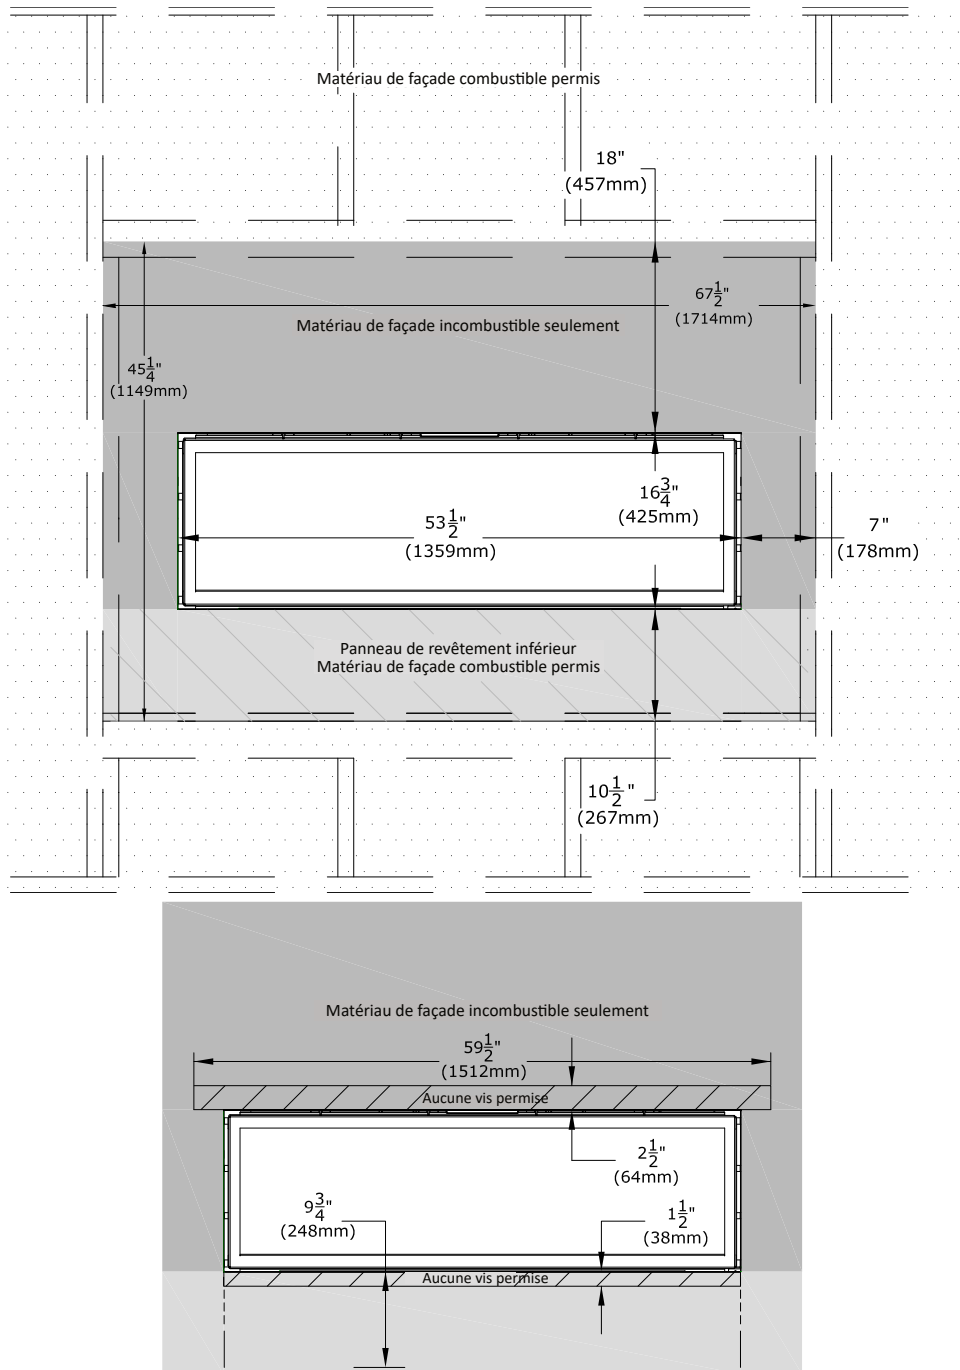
Dimensions minimums des matériaux de façade incombustibles (Callaway ST - Double face)
